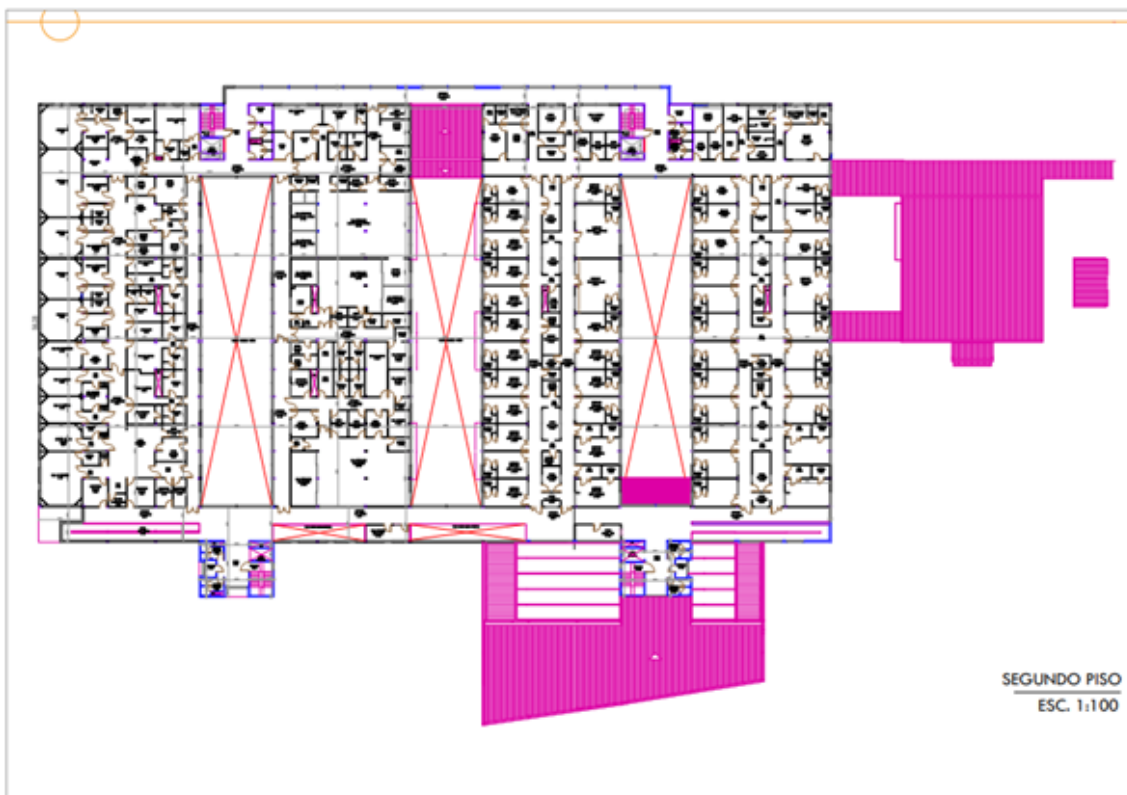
Plano de planta-Segundo Piso-Ver Anexo
